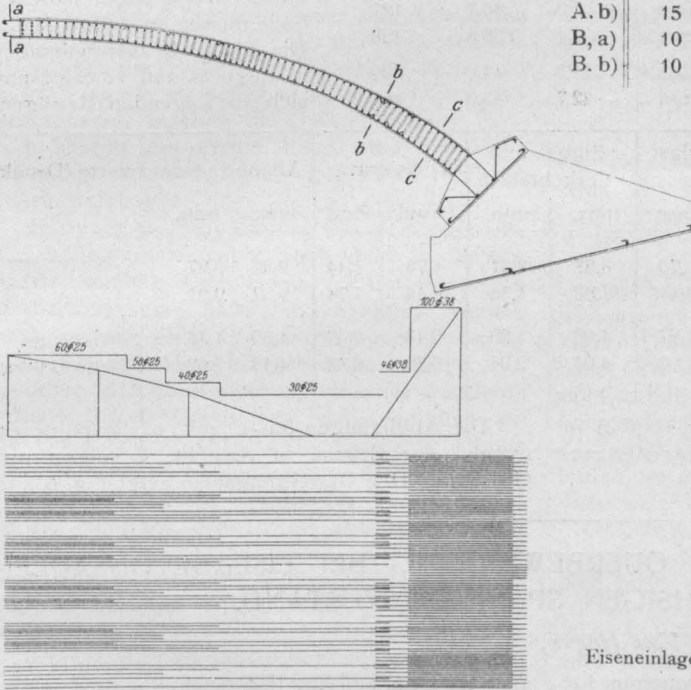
Eiseneinlagen in Gewölbe und Widerlager.
